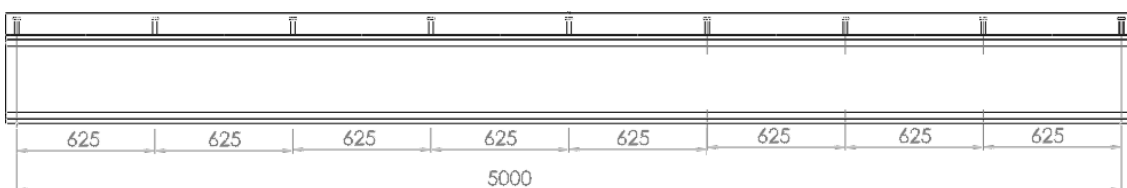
la coupe longitudinale d'une poutre mixte avec 18 goujons
